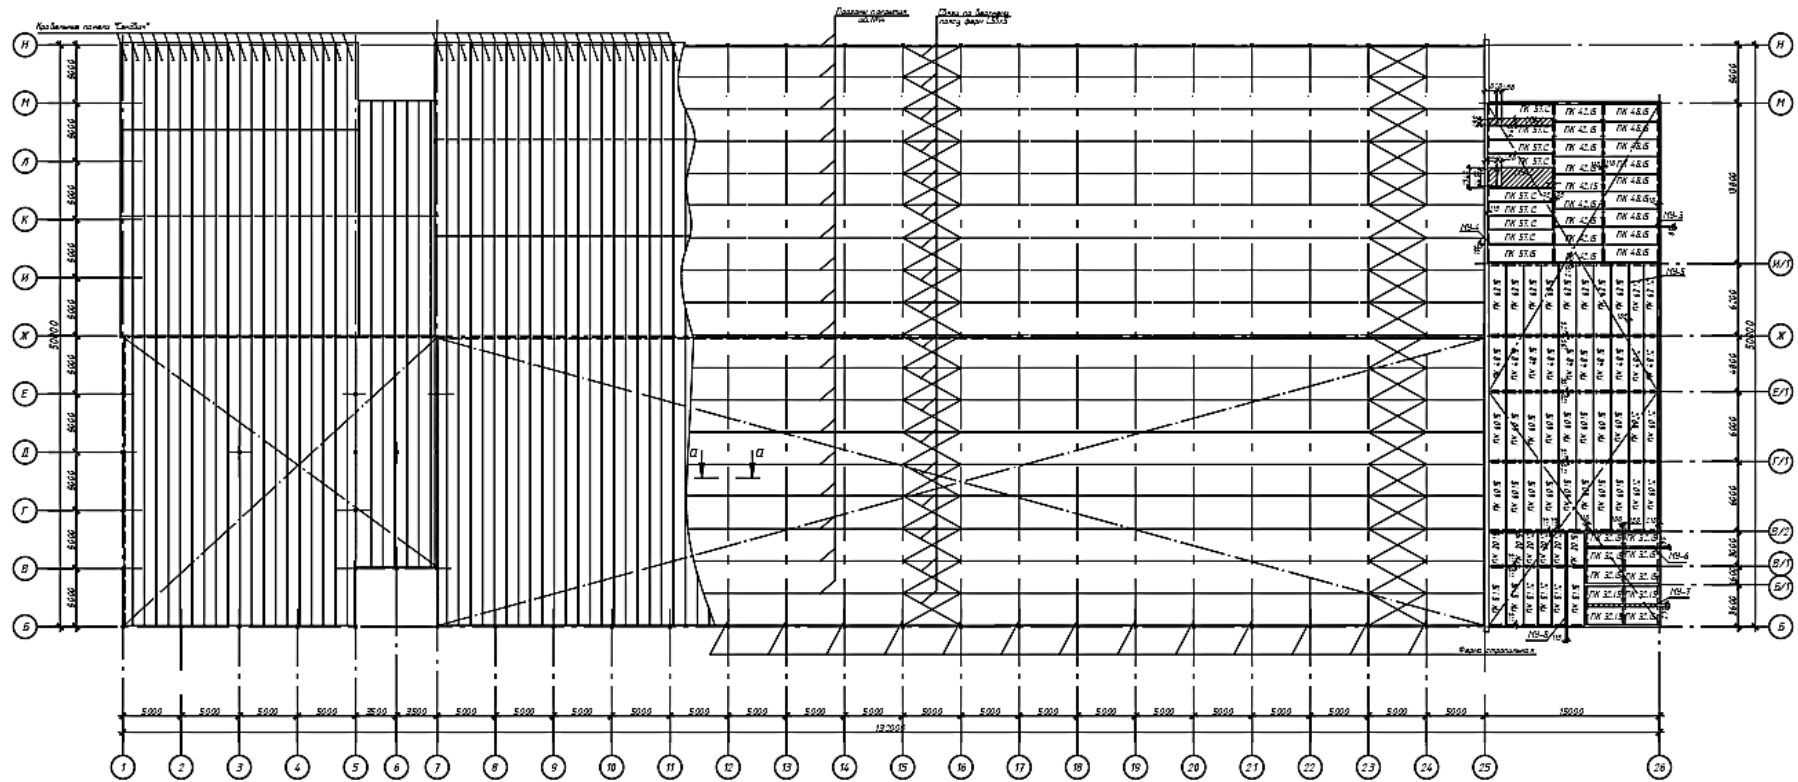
Совмещенный план расположения элементов перекрытия и покрытия
